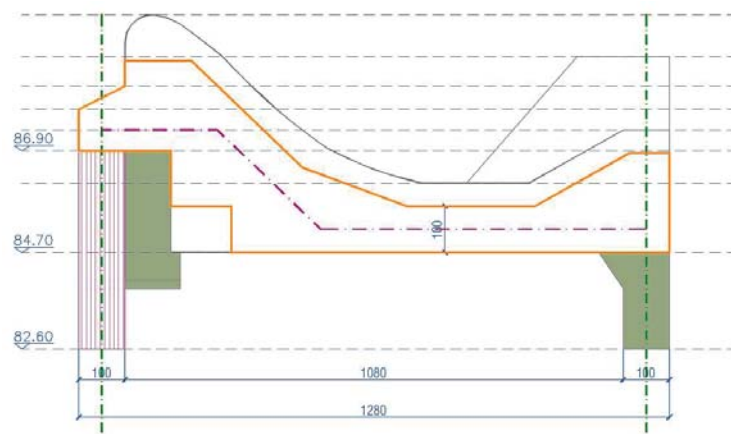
Planimetria delle diaframature di fondazione da progetto 1996 – Tavola 46
